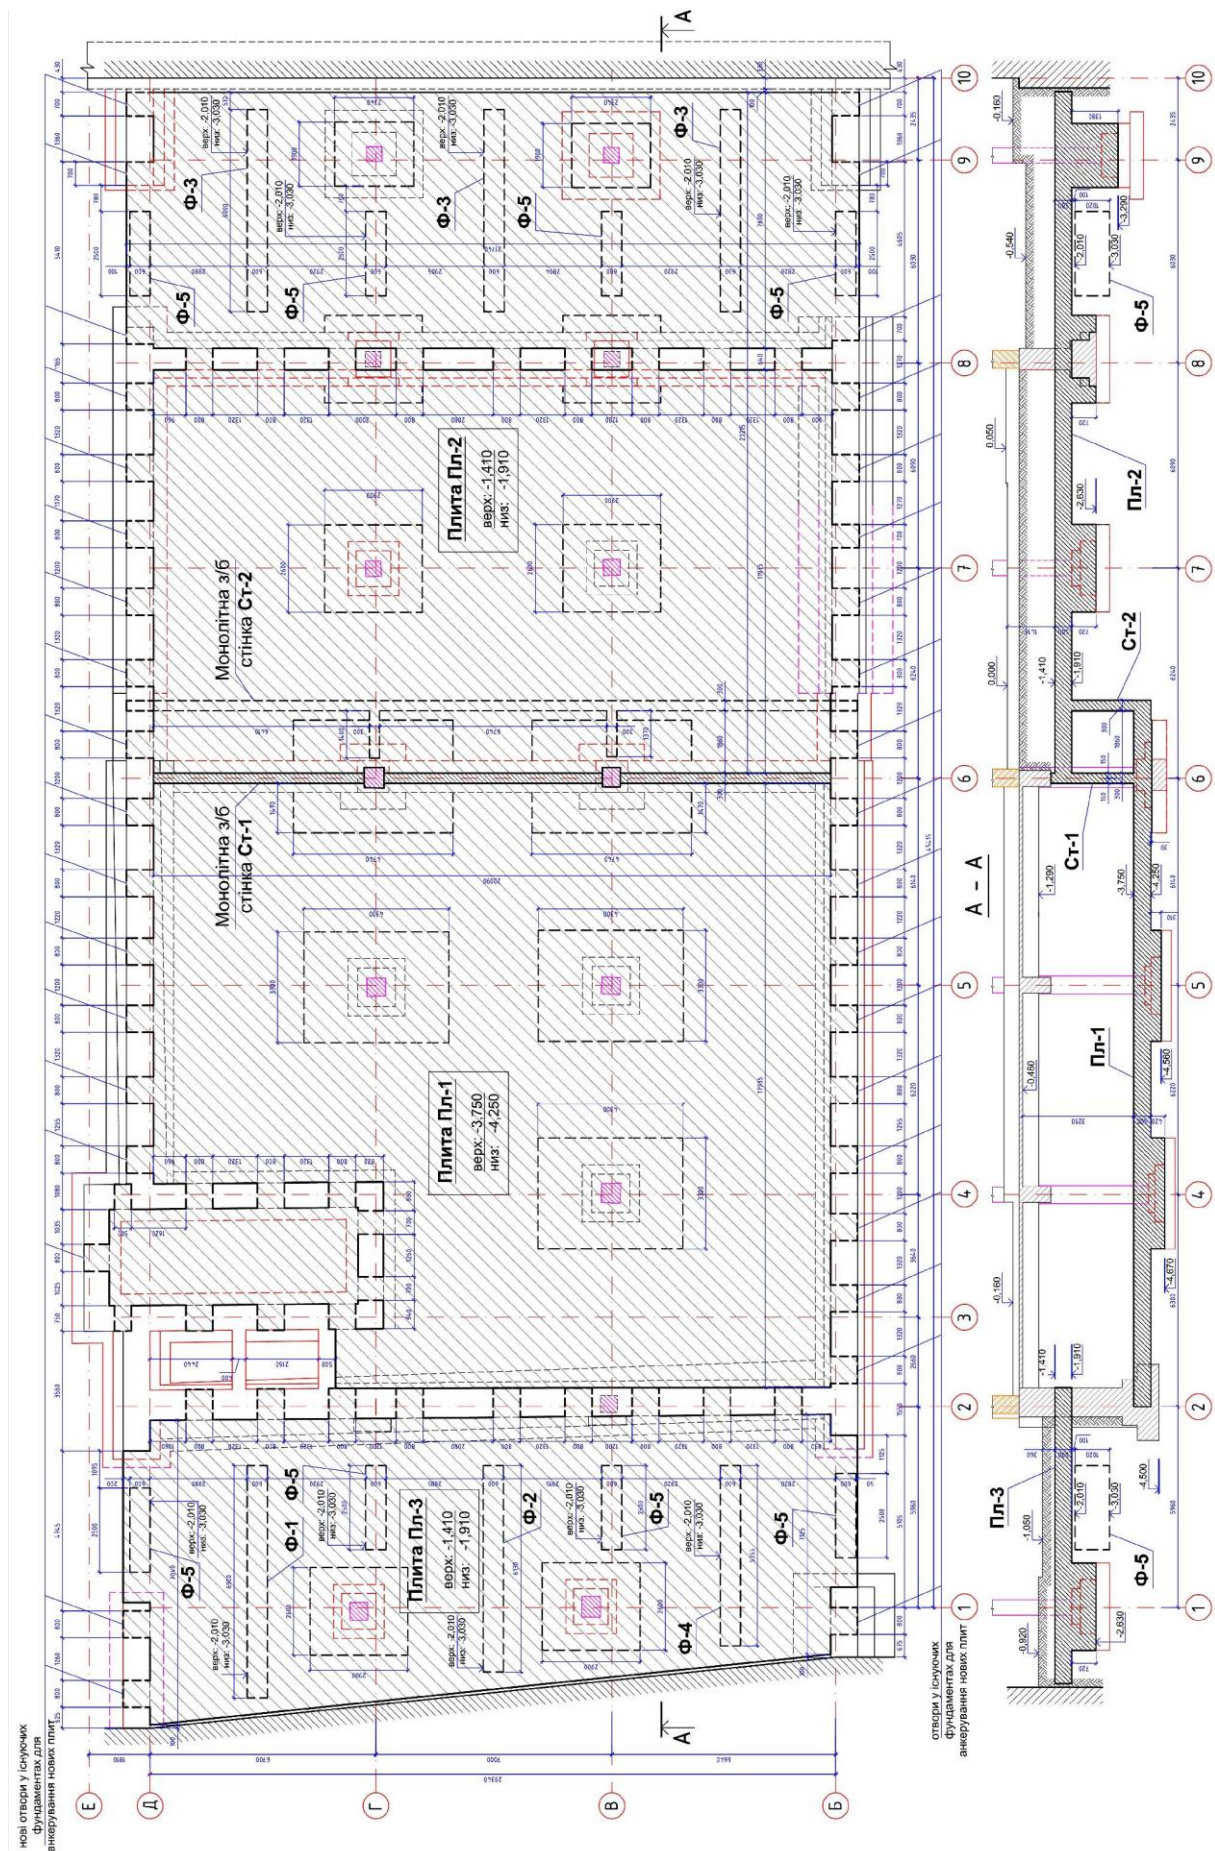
Схема підсилення фундаментів суцільною монолітною плитою
